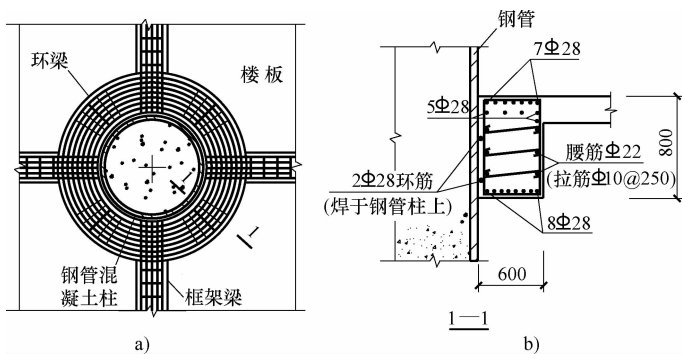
钢管混凝土柱的钢筋混凝土“环梁节点”
